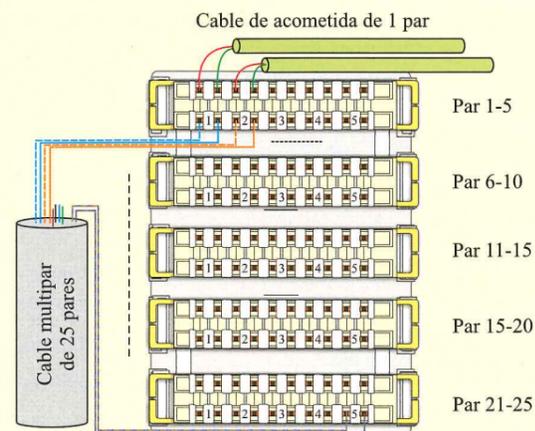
Conexión de un cable de pares en las regletas de conexión.
